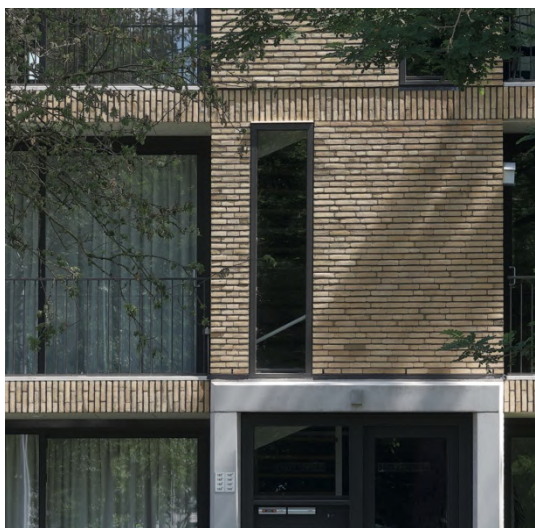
| Aanzicht noordzijde (Raadhuislaan)
